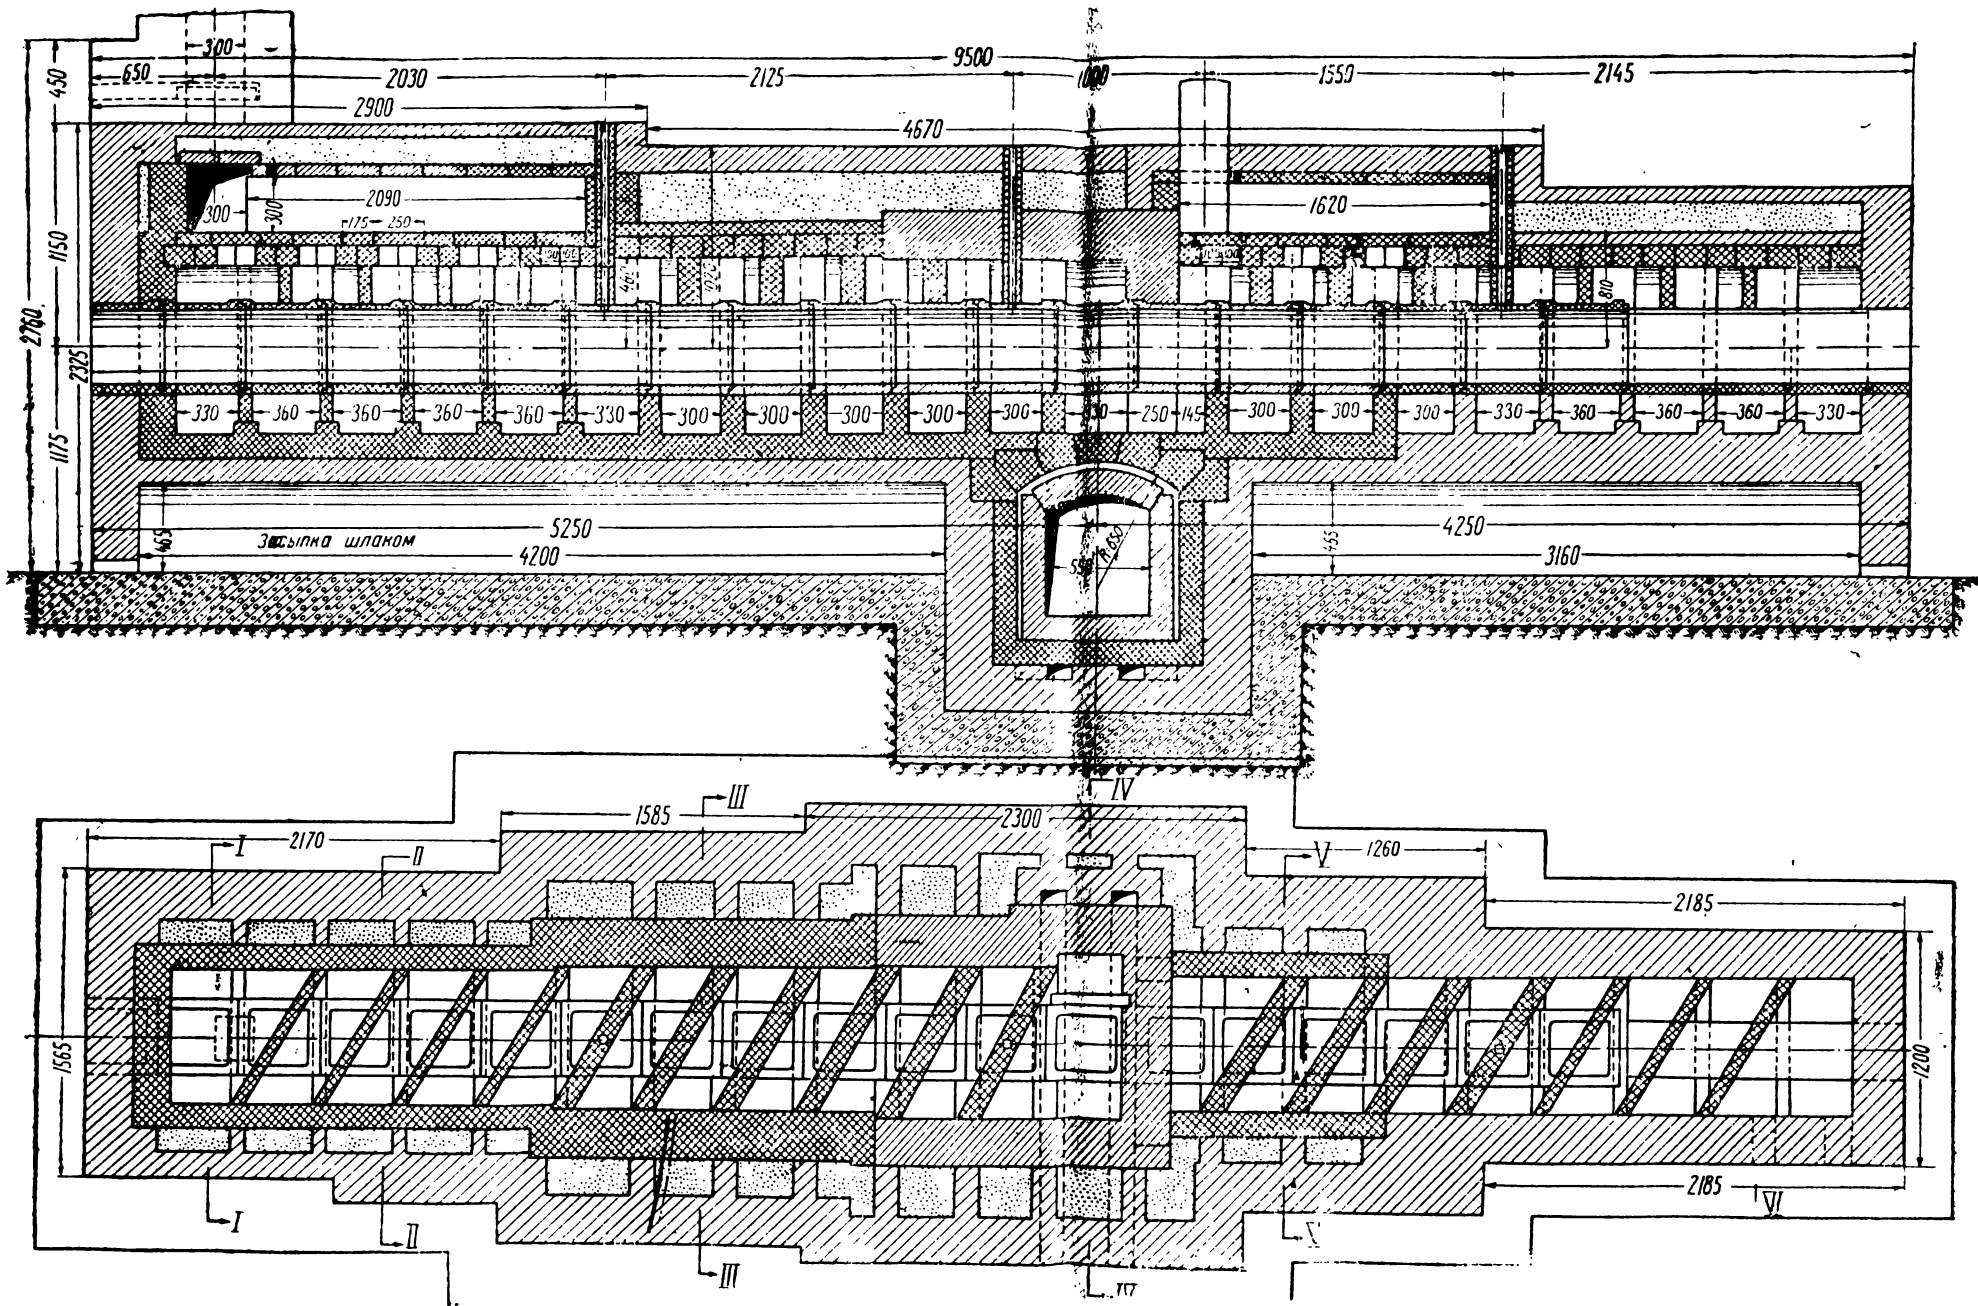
Короткая муфельная туннельная печь системы Попова (план и продольный разрез).
